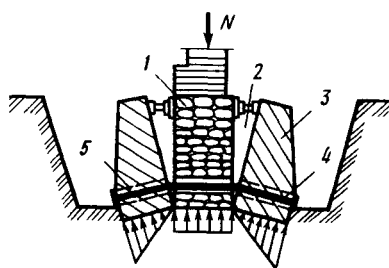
Усиление фундаментов дополнительными блоками, обжимающими грунт оснований при их повороте:
